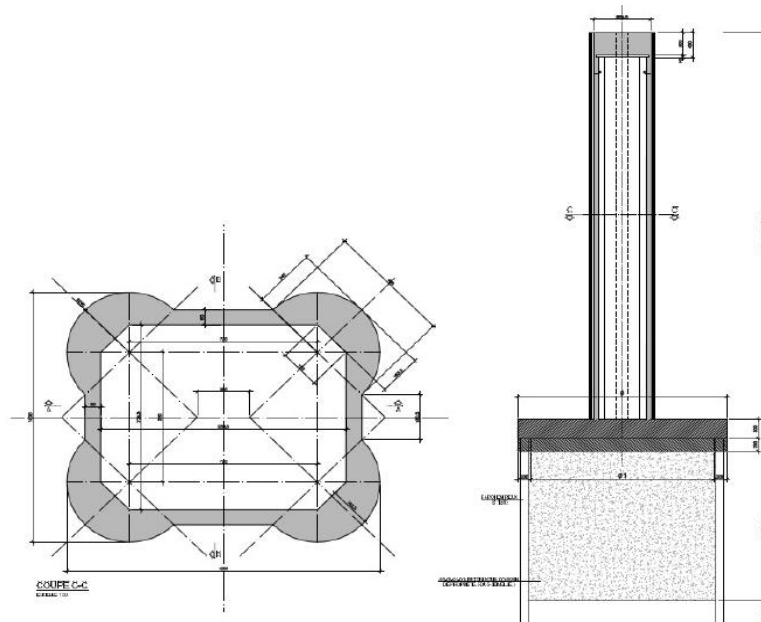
Piles à section variable sur fondations profondes en puis (P6/P7/ P8/ P9/P10/ P11/ P12)
